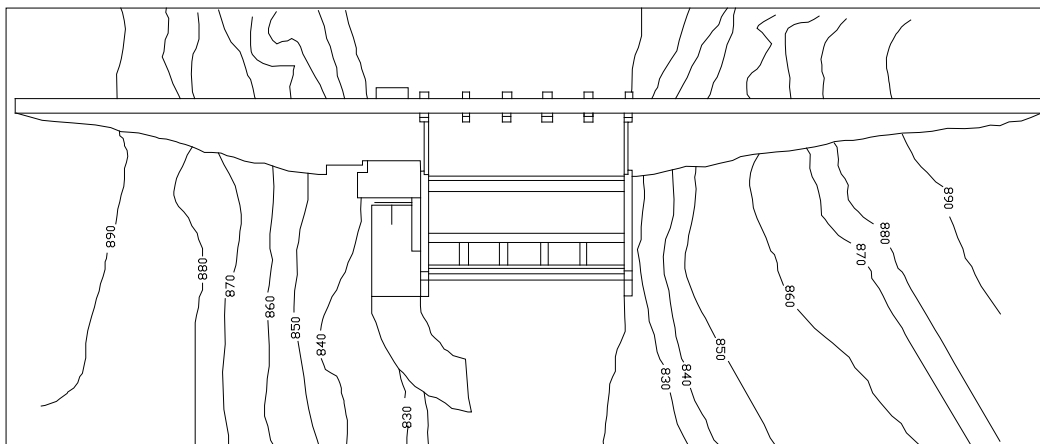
Planta de la estructura de la presa Santa Teresa. Escala 1:1500.
